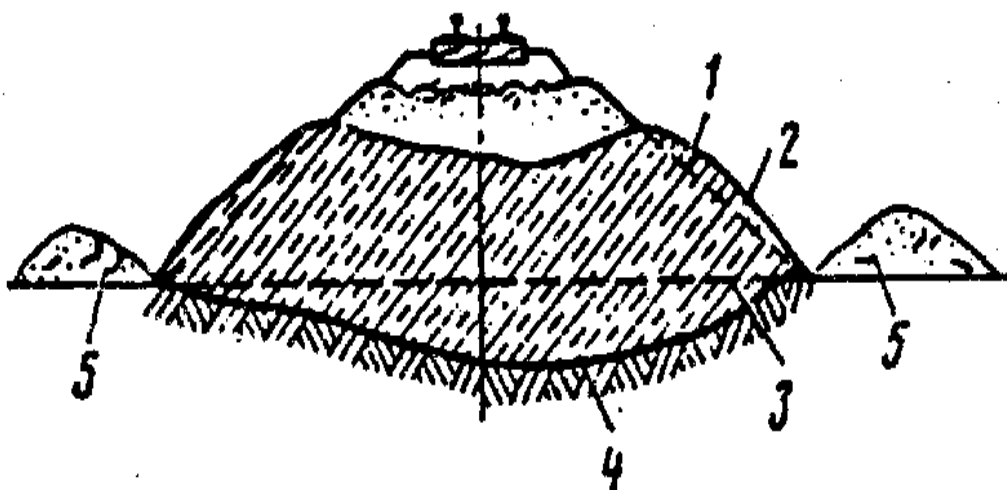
Оседание насыпи вследствие выпирания грунтов основания:
